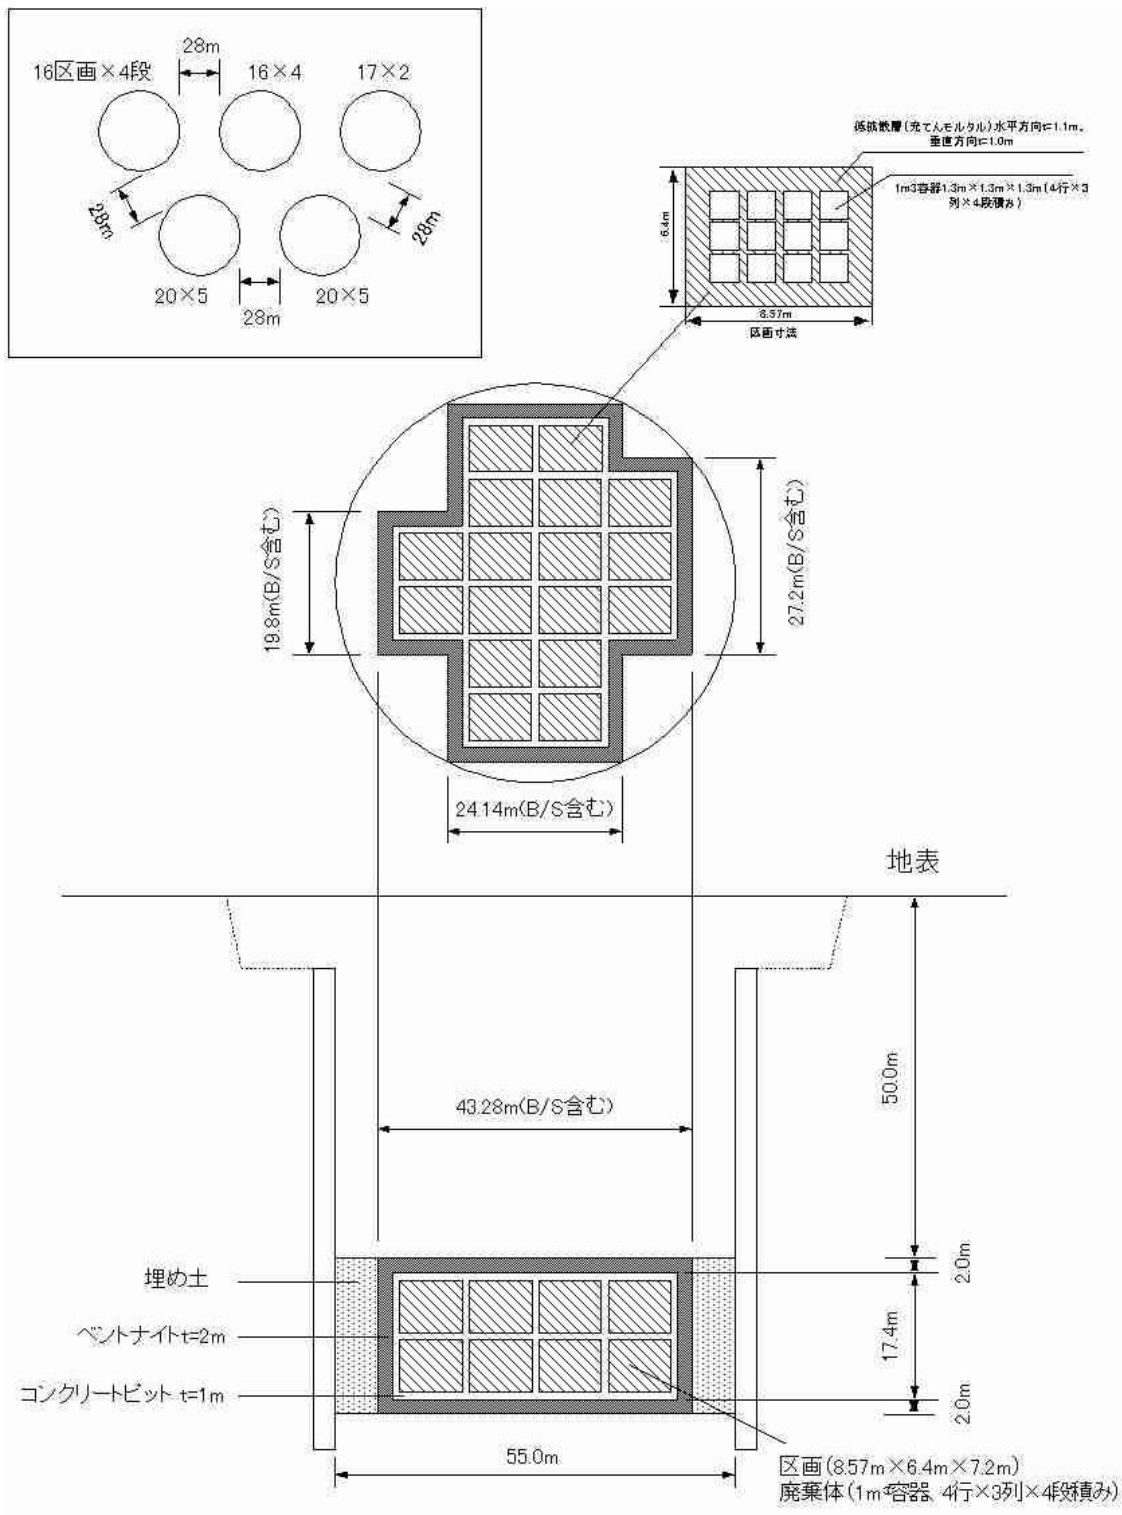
ケース3(増設)の開削サイロ型施設配置図
